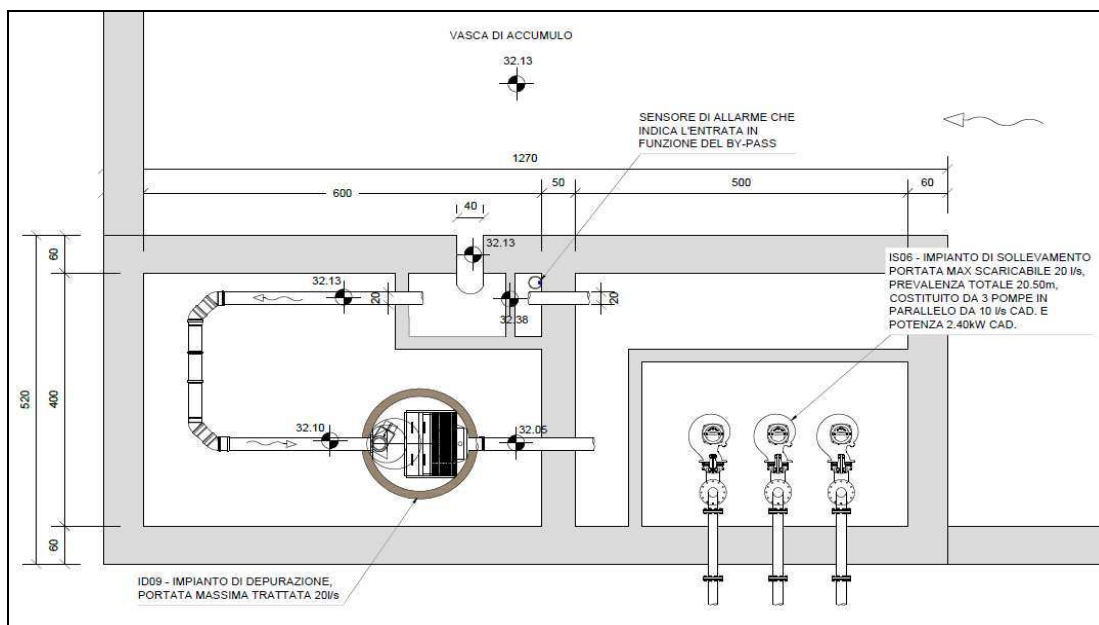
Schema di flusso da Vasca di Accumulo a stazione di sollevamento nella trincea di Corte Tegge
